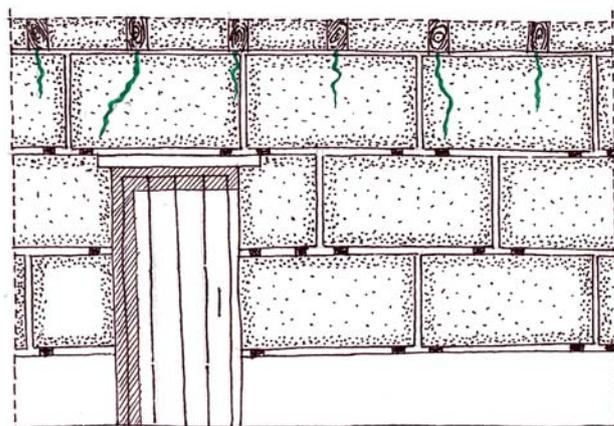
Fisuración de un muro de tapia por punzonamiento en el apoyo de las vigas.
